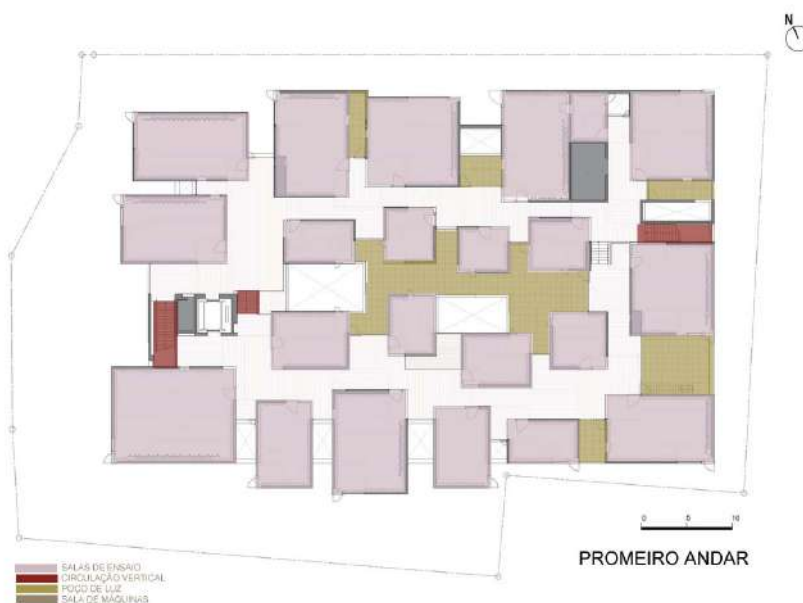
Planta primeiro pavimento. Fonte: ArchDaily editada pela autora.
